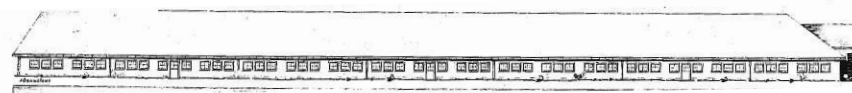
Grundriss Garagen Martinekkaserne
